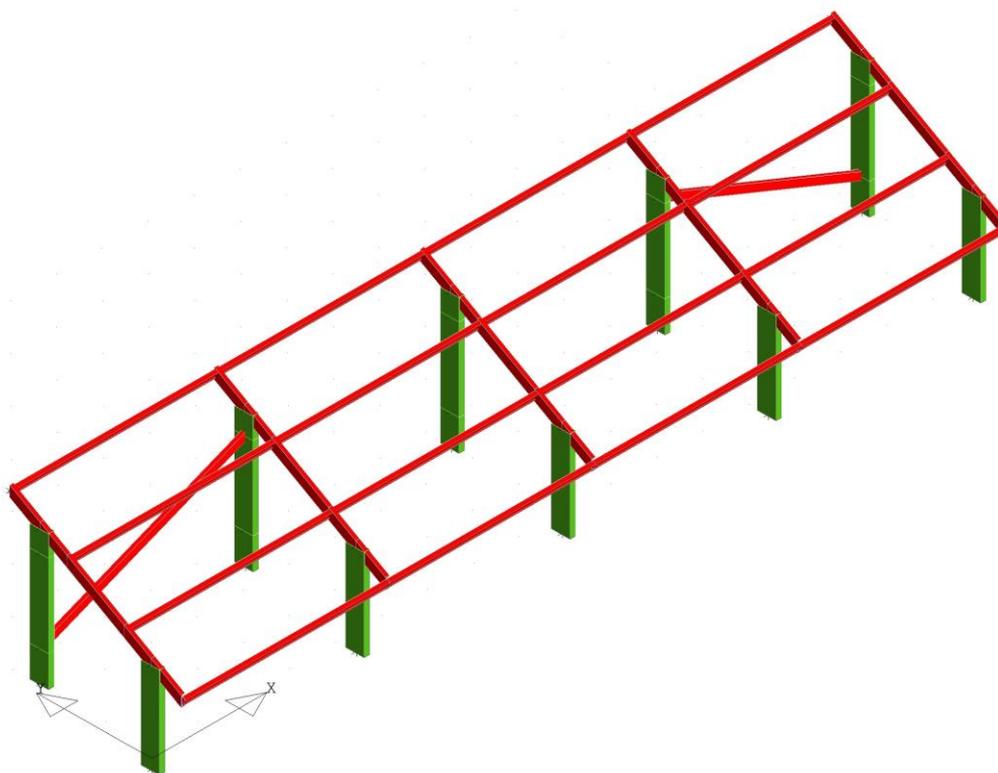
Vista assometrica telaio fisso in aree ad attività zootecnica
